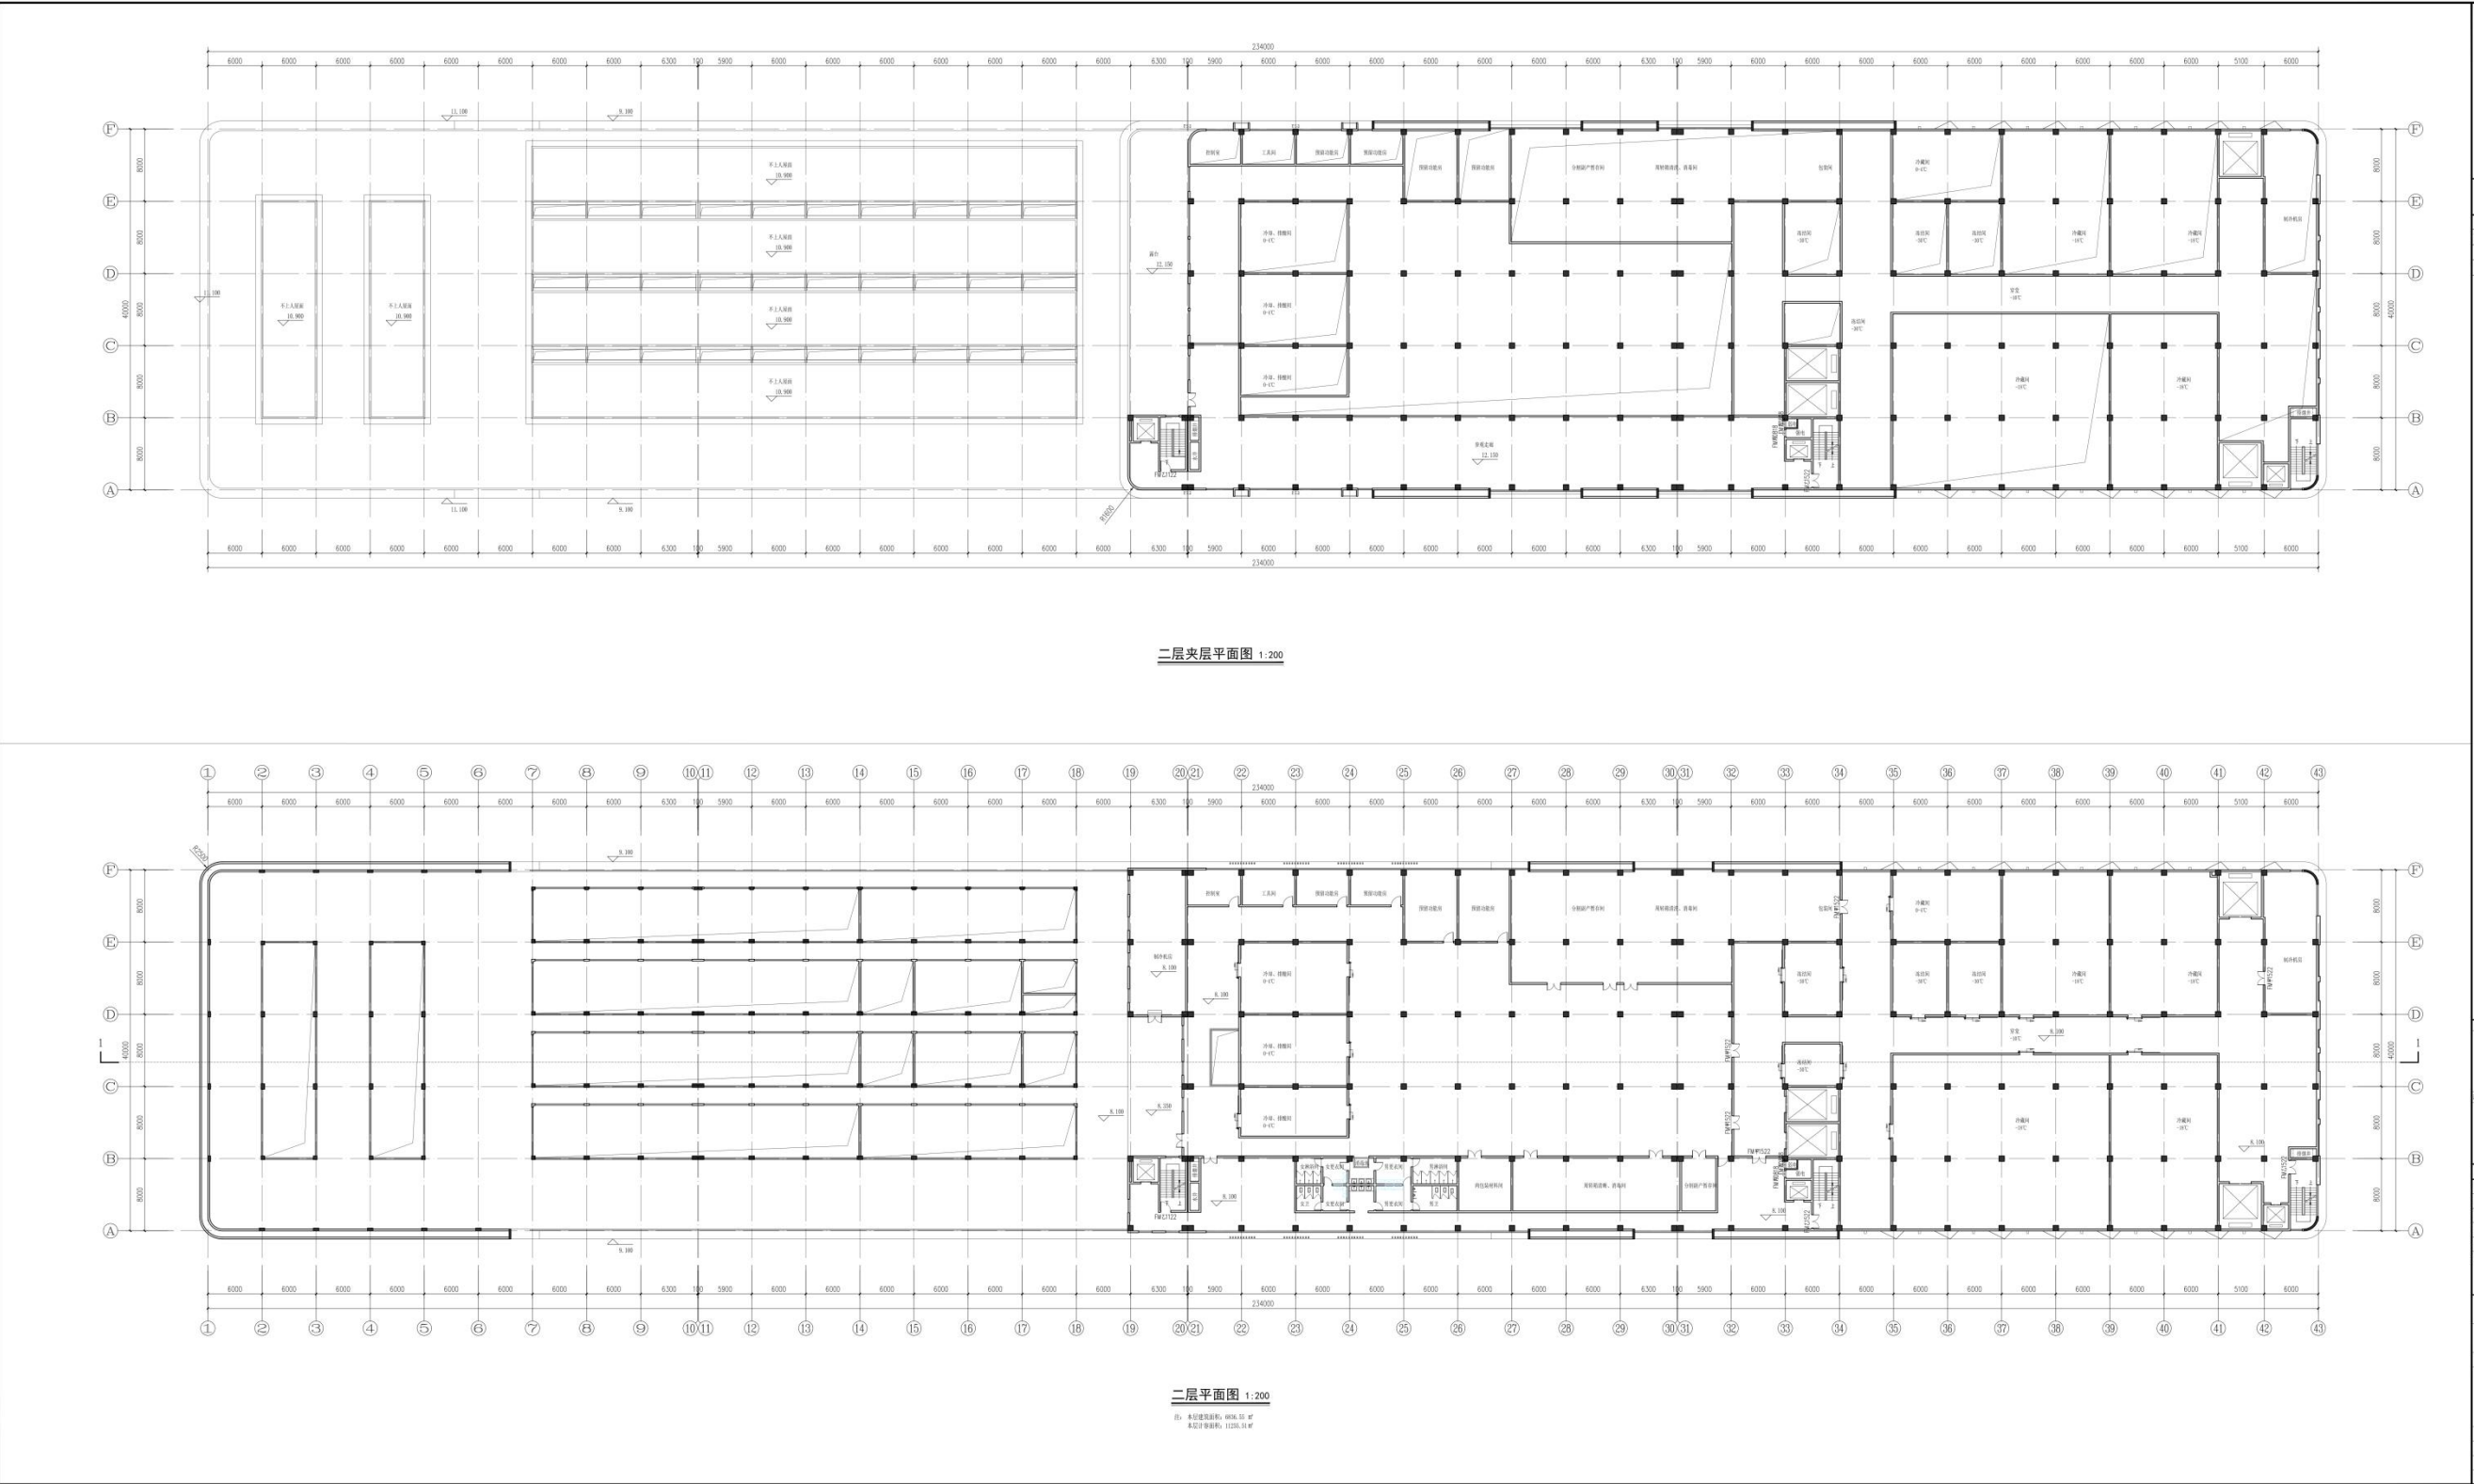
（2 栋肉食加工车间及冷库）二层平面图
